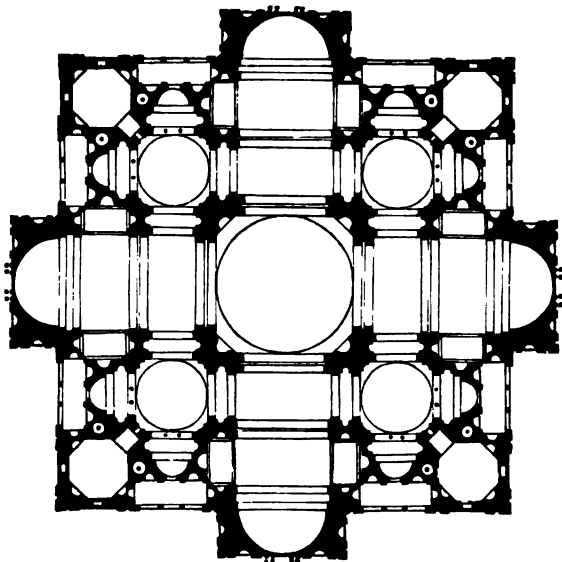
Grundriss der Peterskirche zu Rom nach Bramante's Plan.
